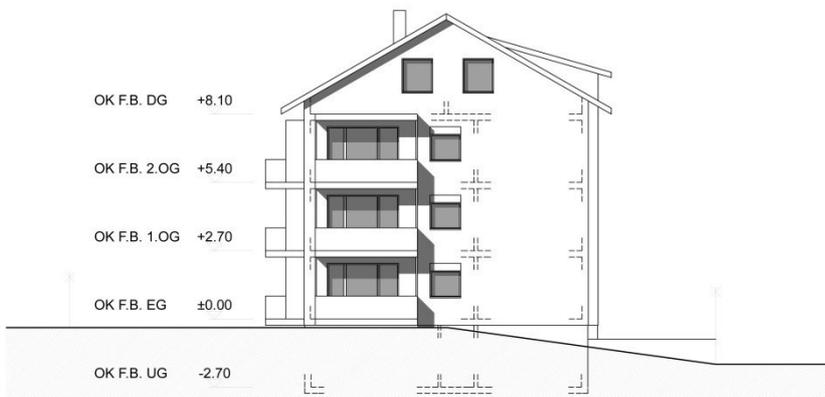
Fallbeispiel, Plan Südwest-Fassade
